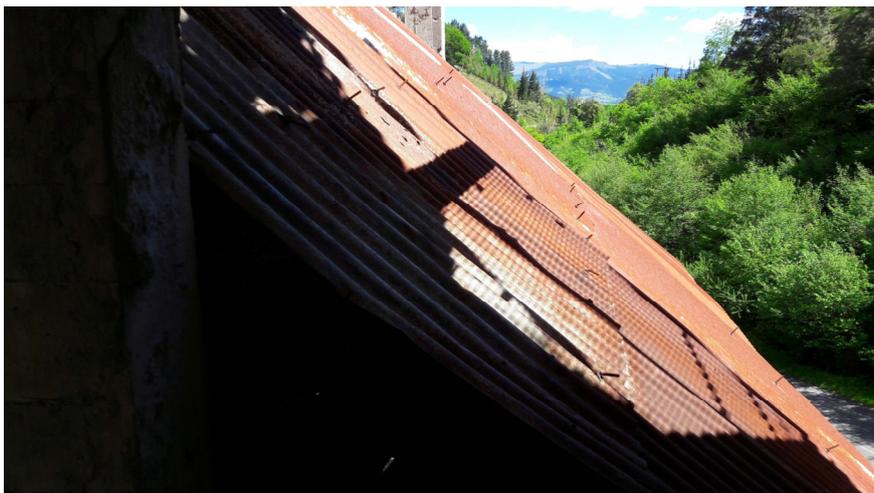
Cubiera metálica en avanzado estado de oxidación.
